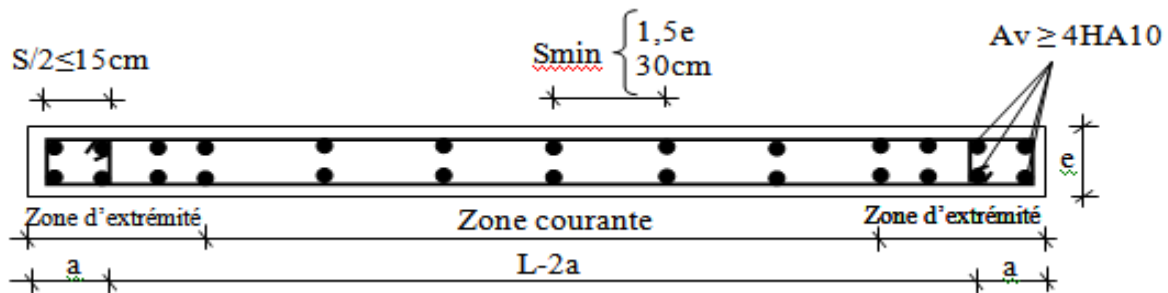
Disposition des armatures verticales dans les voiles
